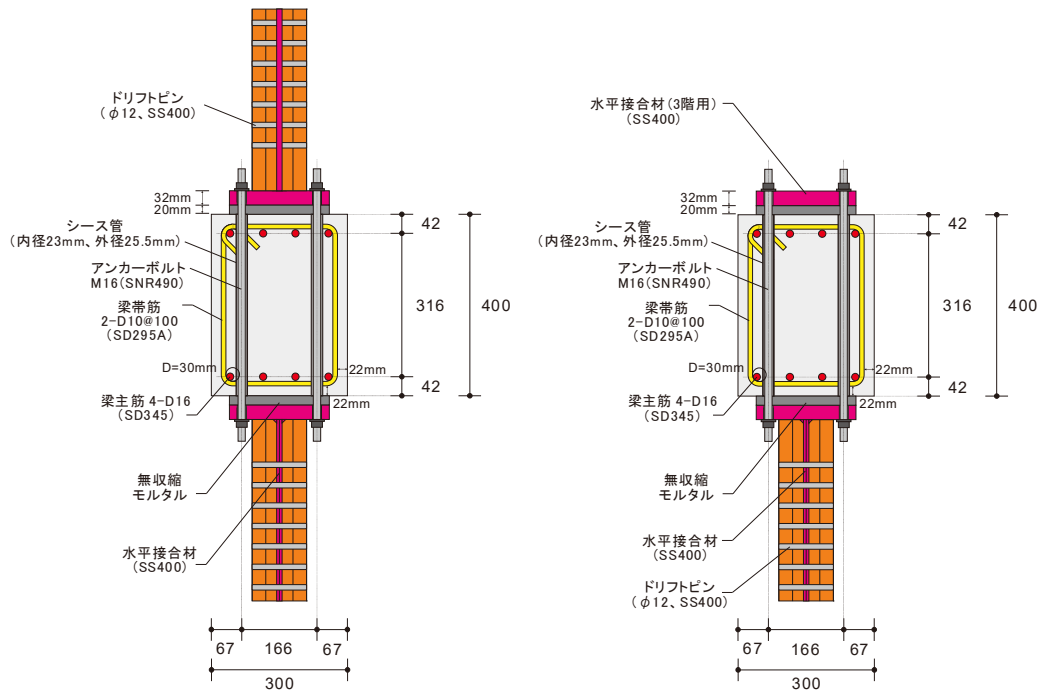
試験体 A の CLT 袖壁取り付け後のはりの断面図
